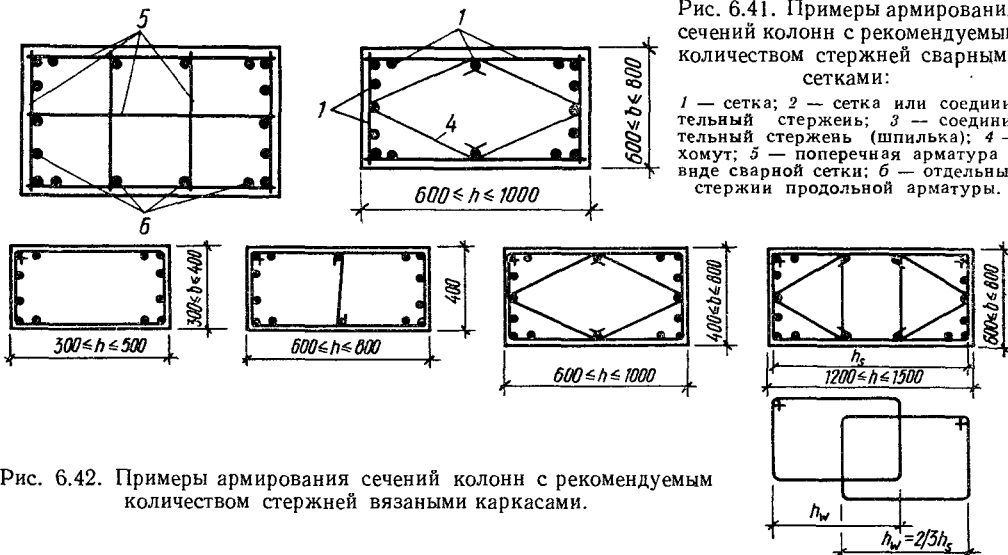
Примеры армирования сечений колонн с рекомендуемым количеством стержней вязаными каркасами.
